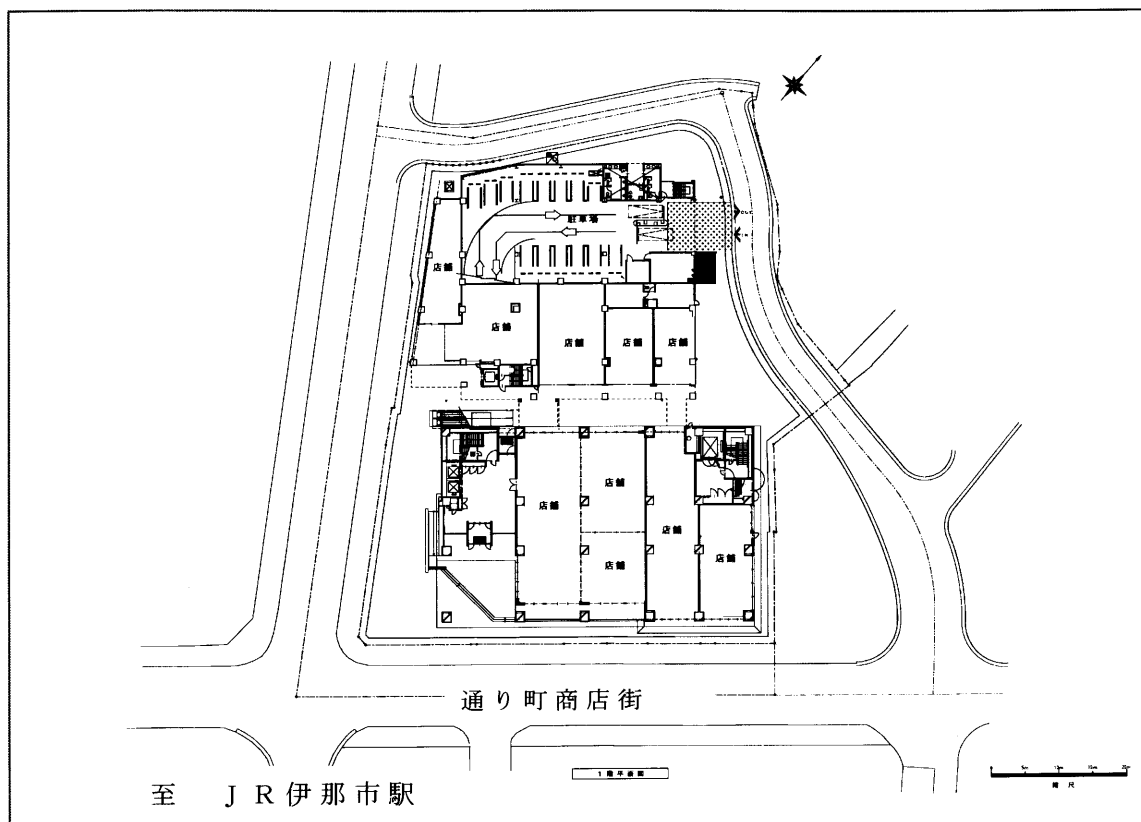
2 - 1 1 再開発ビルいなっせ配置図・1階平面図
